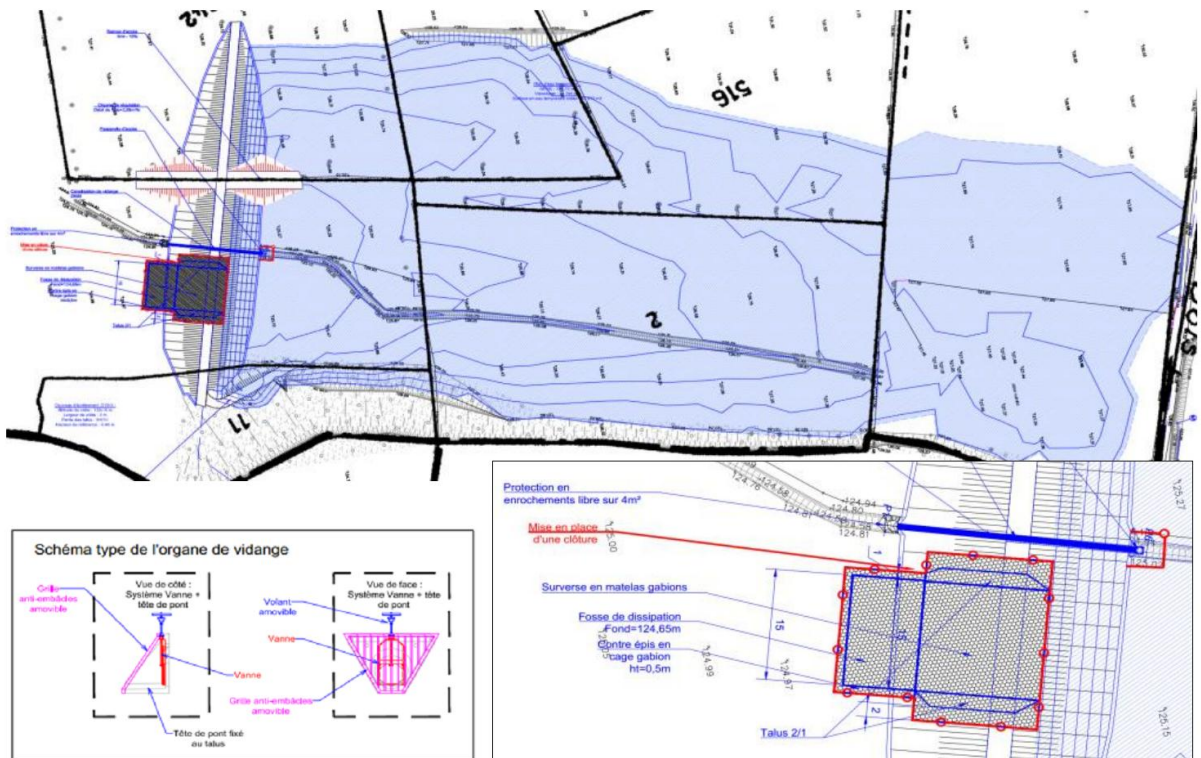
Extrait du plan de masse – Ouvrage D15-3
